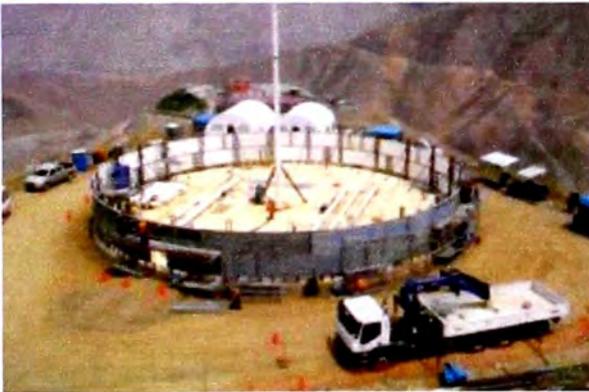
Método del Gateo (Soldadura del Segundo Anillo y columnas principales)
